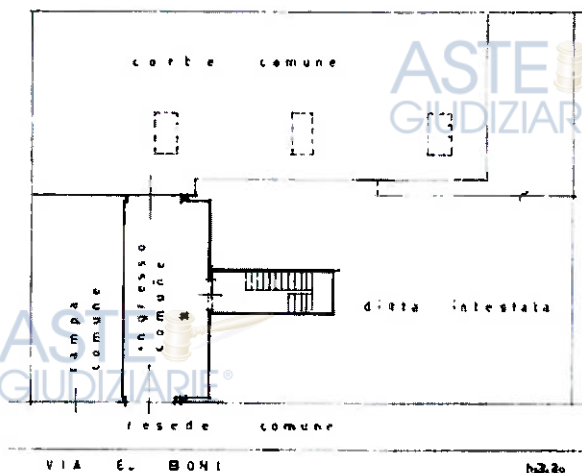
PLANIMETRIA CATASTALE - FOGLIO 63 PART. 536 SUB. 3 - PIANO TERRA
